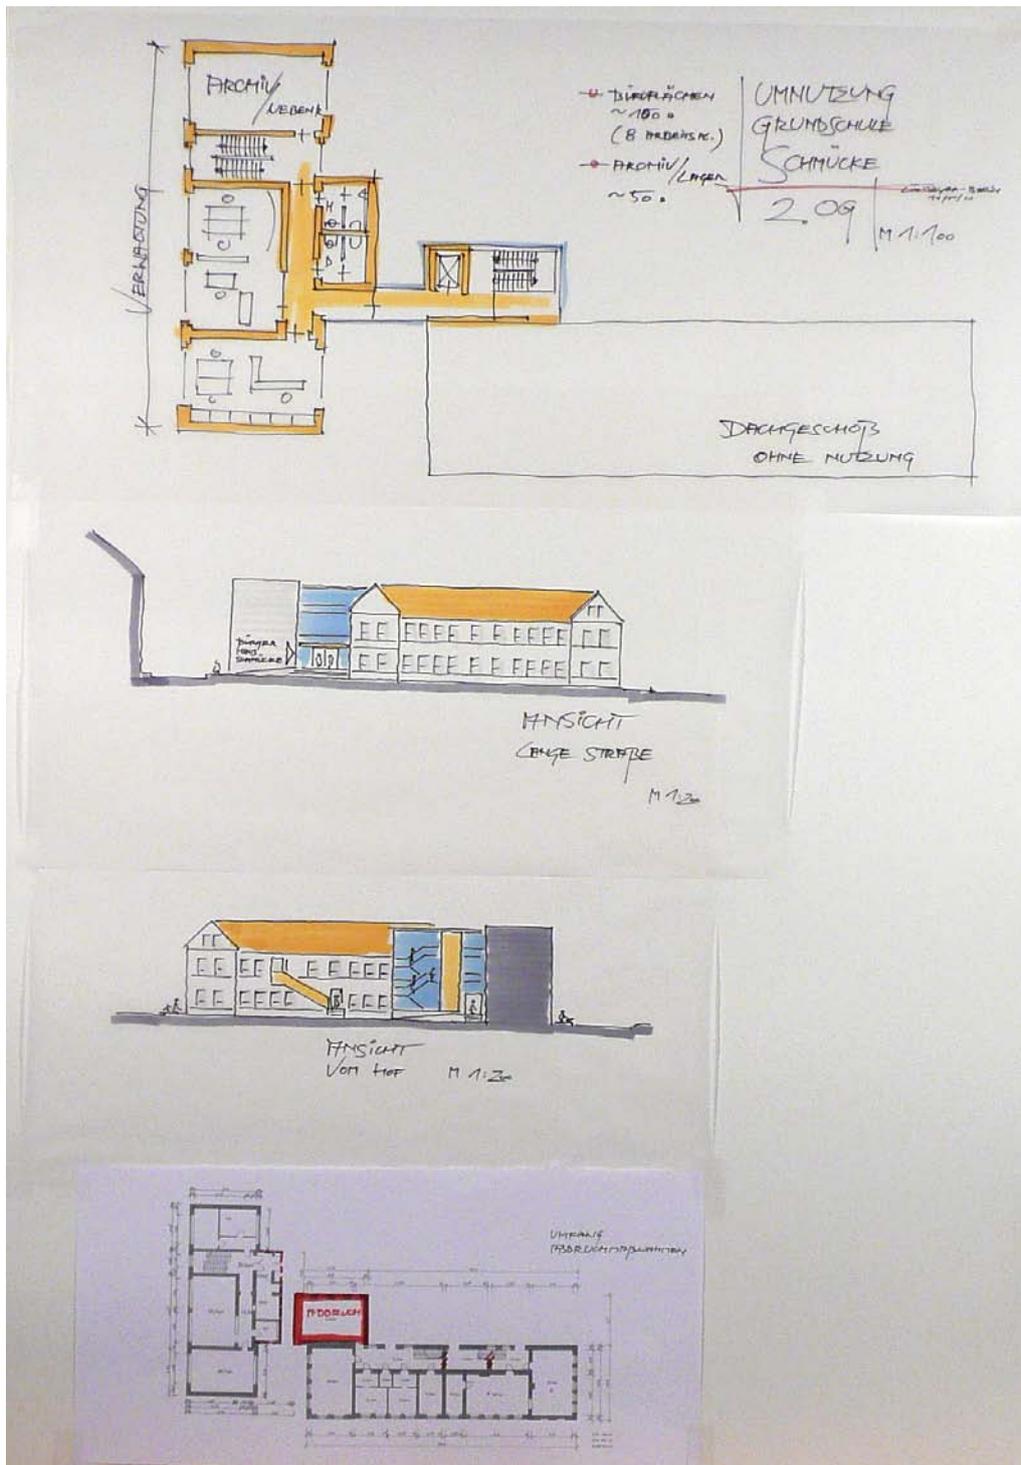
Heldungen Grundschule Schmücke Ansichten, Grundrisse und Abrissplan
